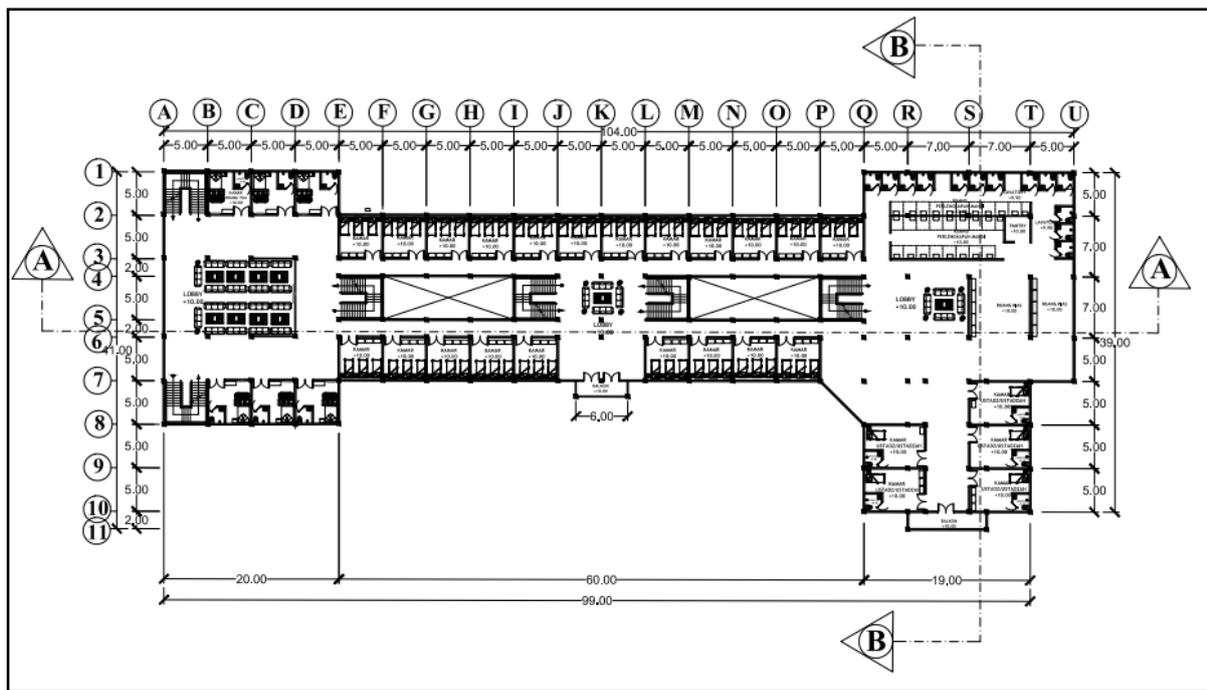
Denah Asrama Lantai 1 Pesantren Ushuluddin Singkawang dengan pendekatan Arsitektur Islam
